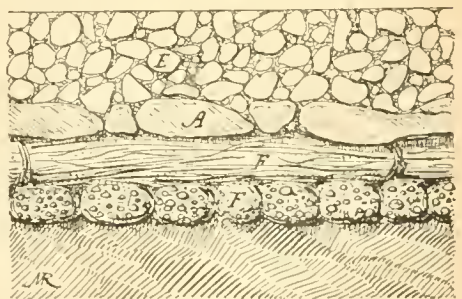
Coupe verticale d'un empierrement sur un sol humide.
